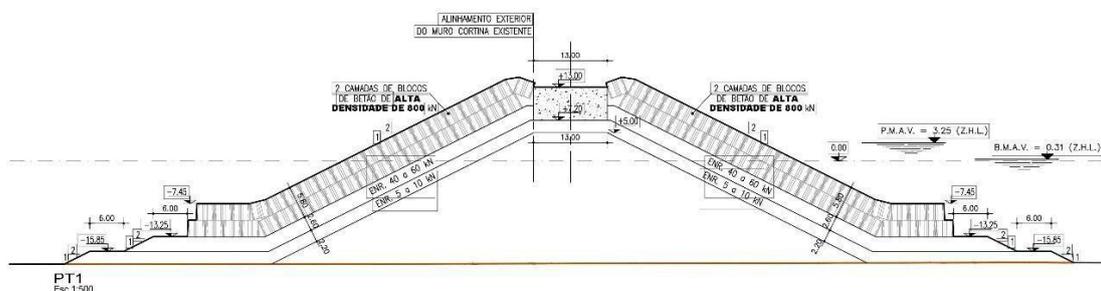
Estrutura do perfil na cabeça do quebra-mar (PT1)
